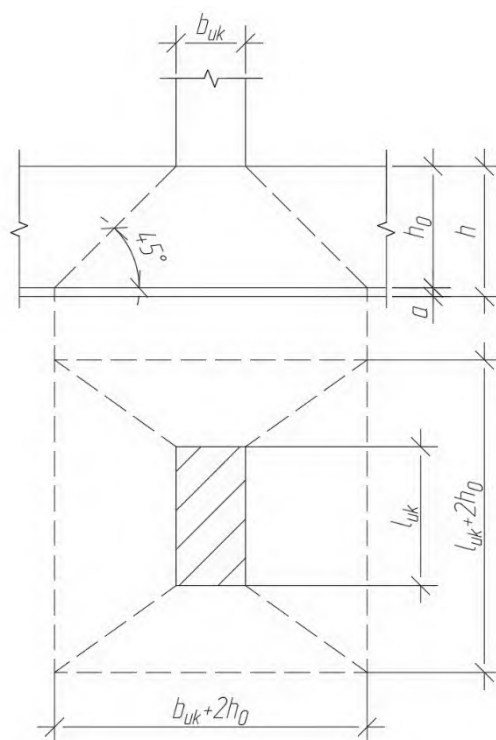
Схема до розрахунку фундаментної плити на продавлювання
